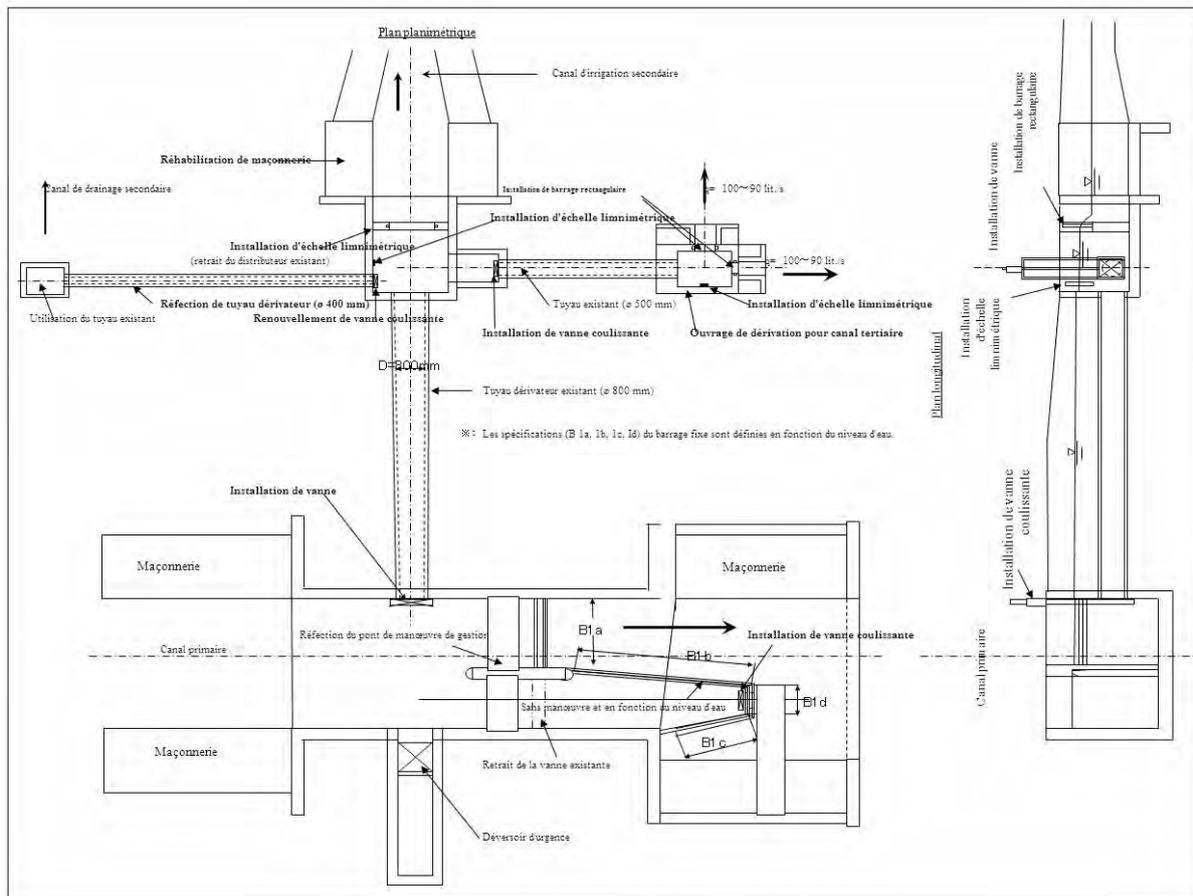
Plan de base pour la réhabilitation des ouvrages de dérivation pour les canaux primaires et secondaires
